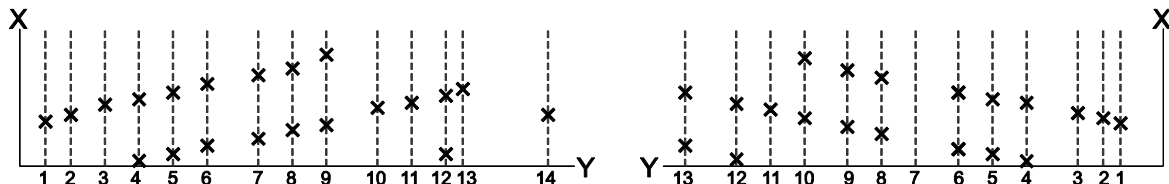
Posição dos cabos de pré-esforço em duas posições nas vigas perto dos encontros.
